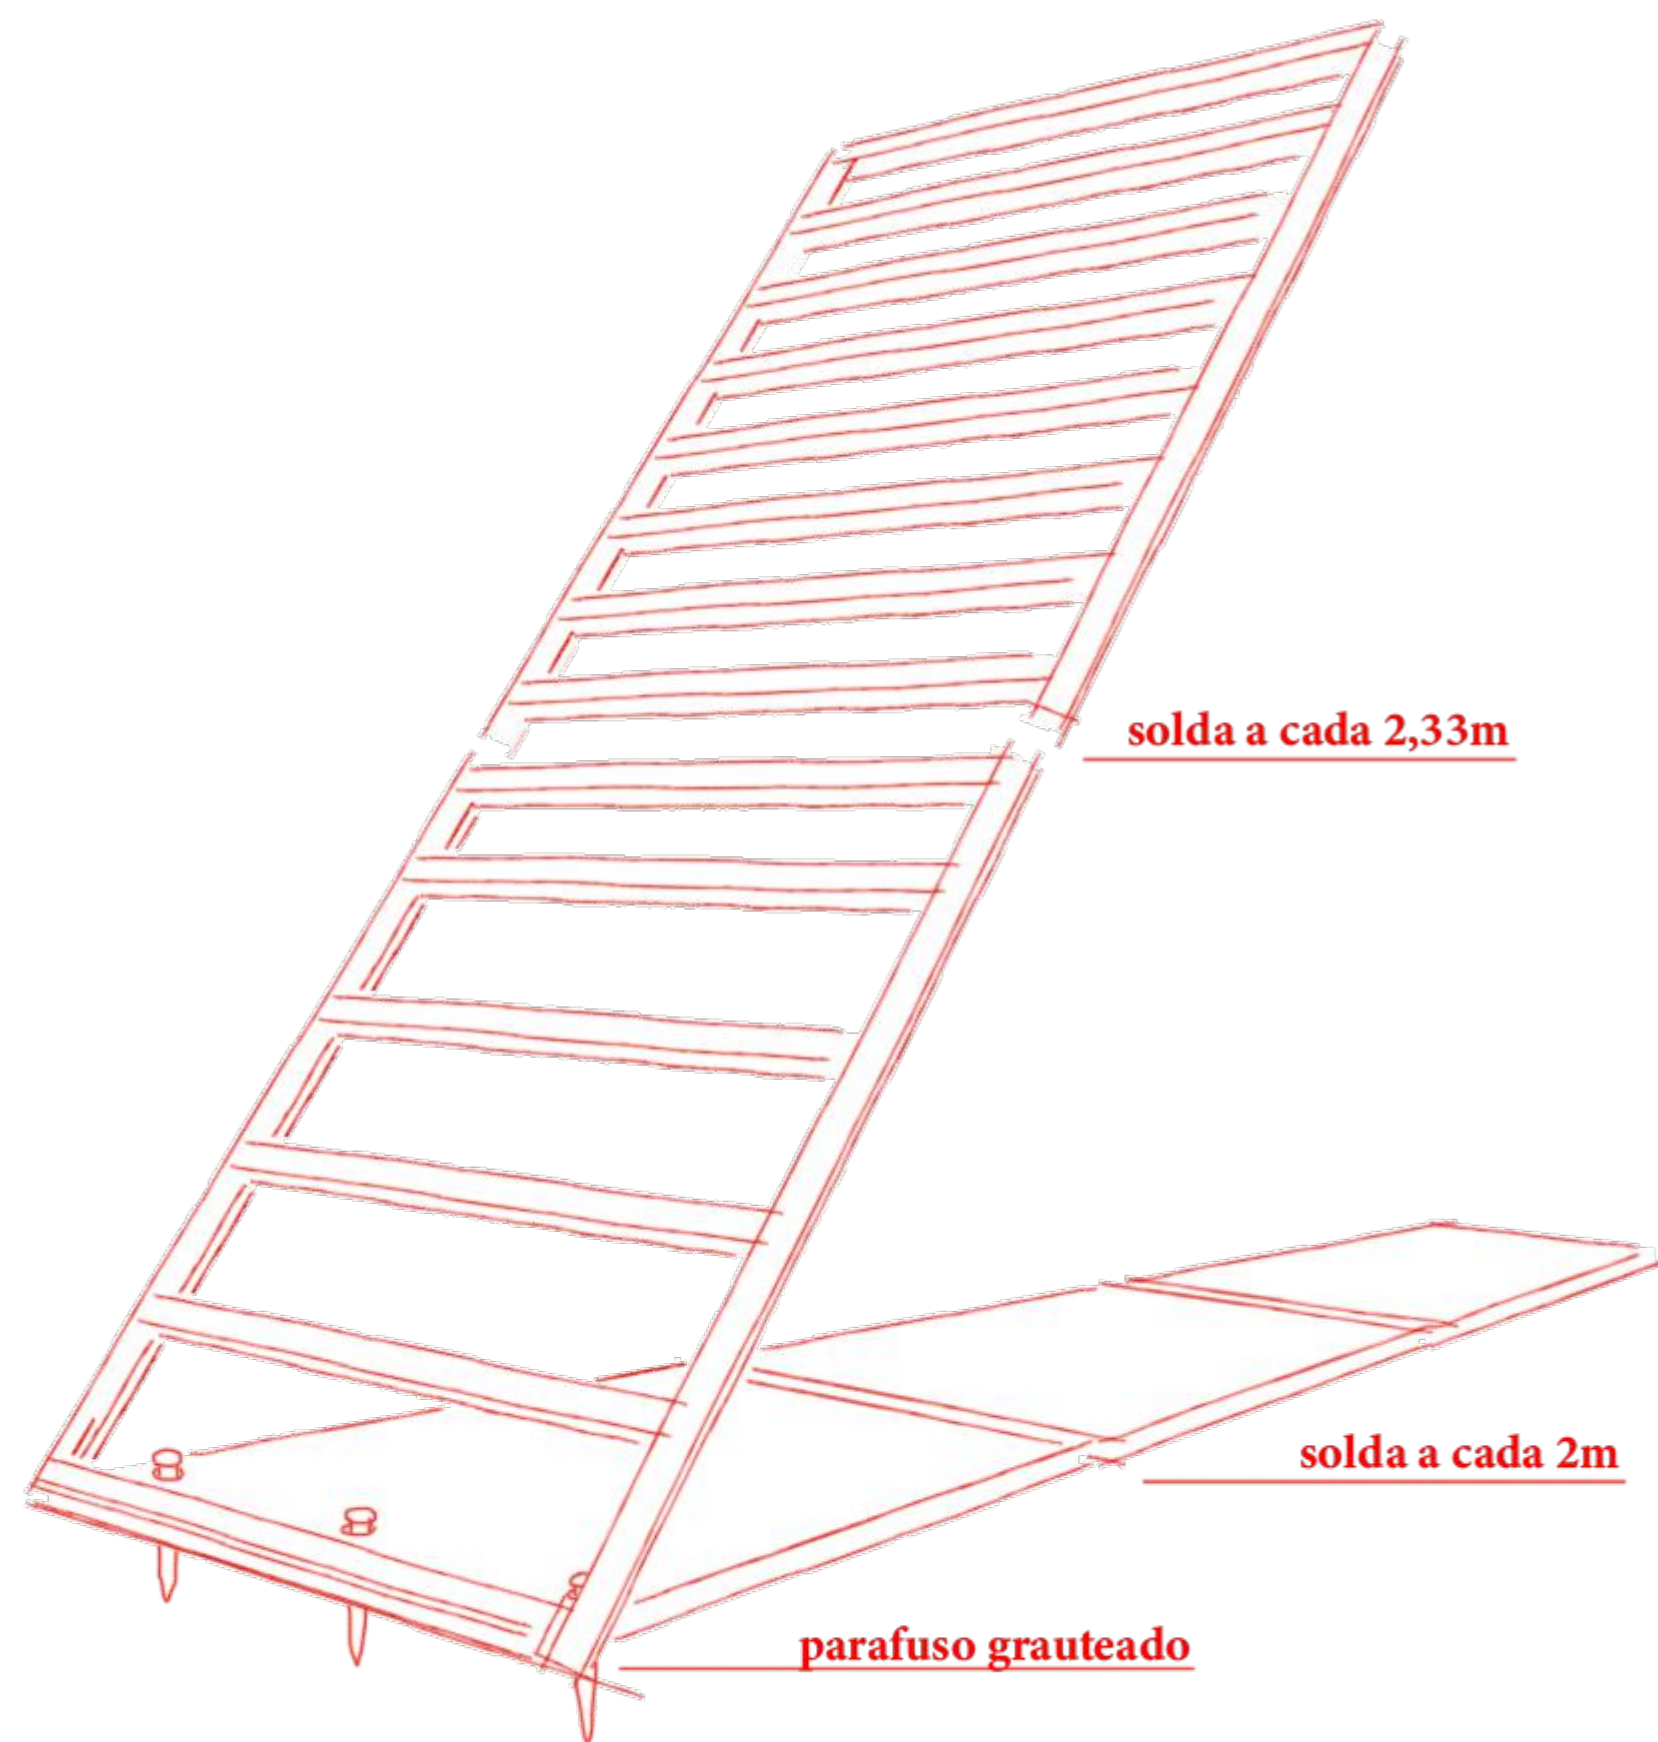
Croqui esquemático de executivo da Instalação Suba-me/ Upload-me
